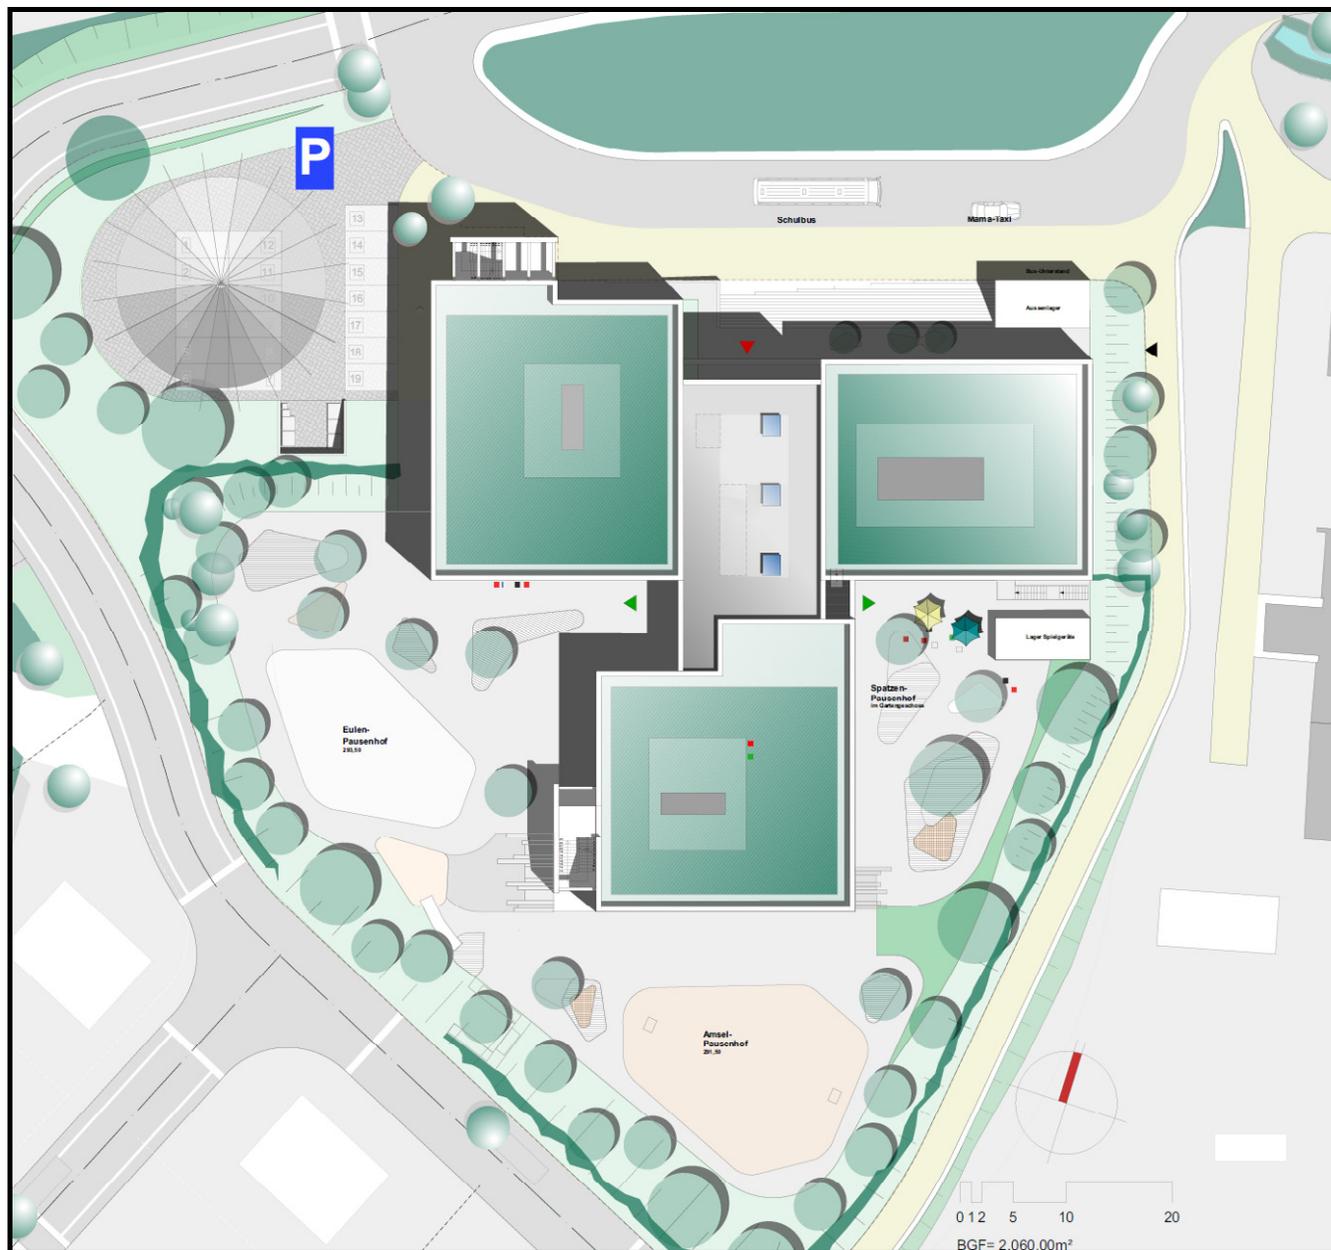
Lageplan der geplante Löwen-Grundschule - Stand 09.07.2019
